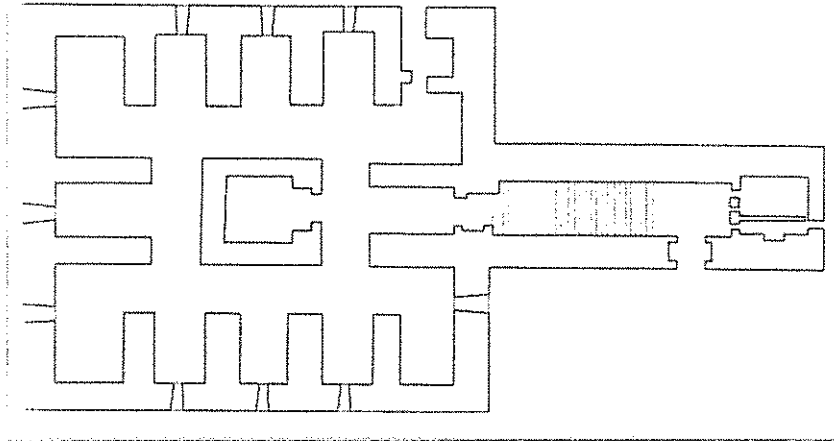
مسقط أفقي تخيلي لبوابة البرادعين الموحدة، عمل الباحث.
